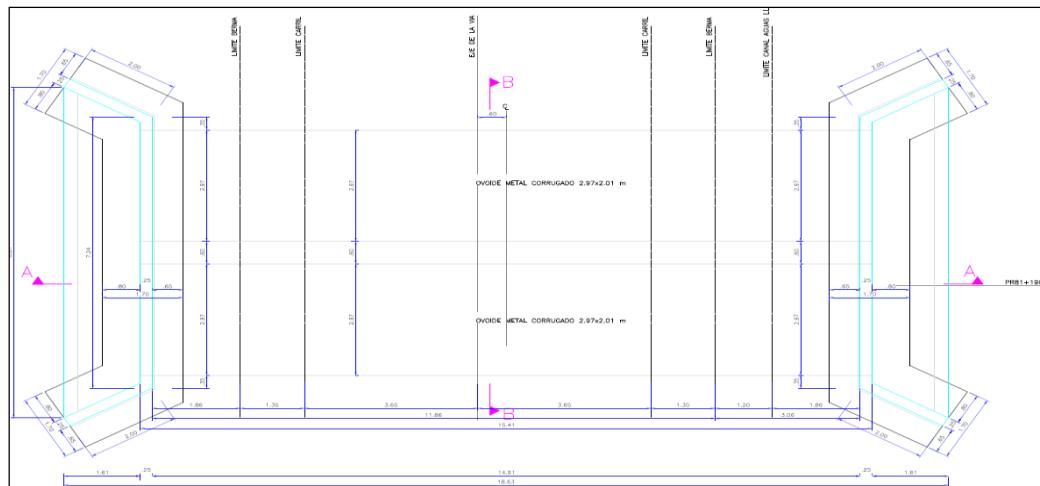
Planos de diseño de planta Box Culvert corte B-B para la obra de drenaje PR81+190
